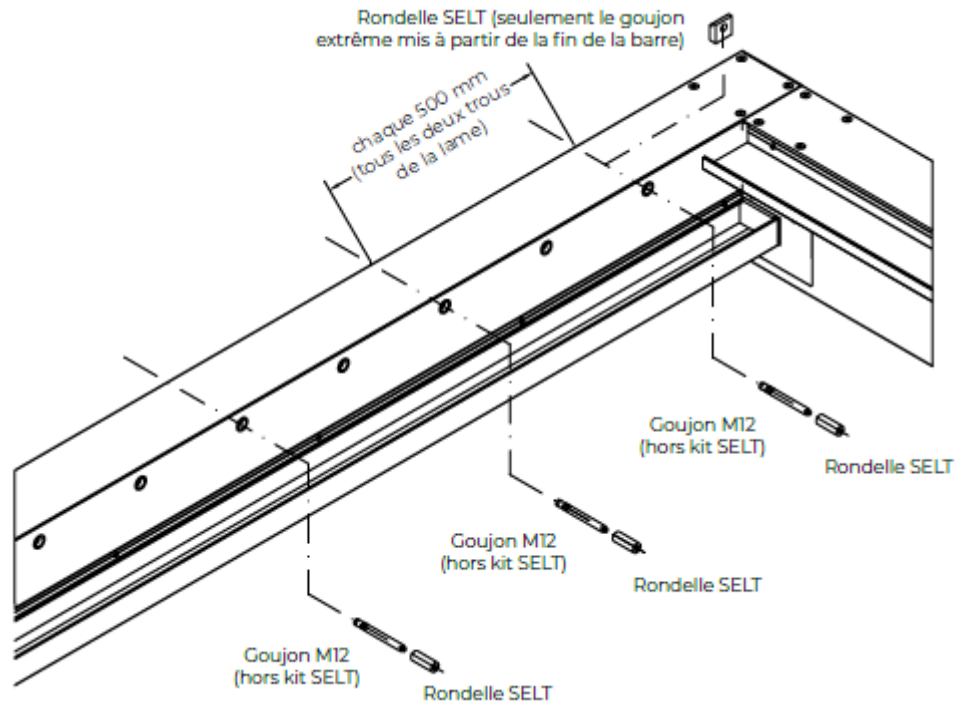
Ancrage au mur sur les poutres longitudinales - solution privilégiée (alternativement possible sur les poutres transversales). Distances d'ancrage de 500 à 750 mm (sur les extensions de trous) - en fonction de la technologie.
